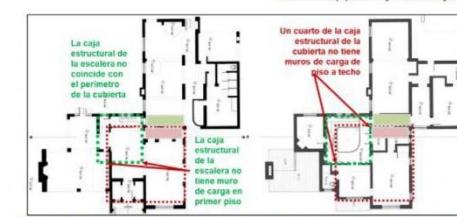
(Izq.) primer piso, (der.) segundo piso. Planos 2025 (muros demolidos).
